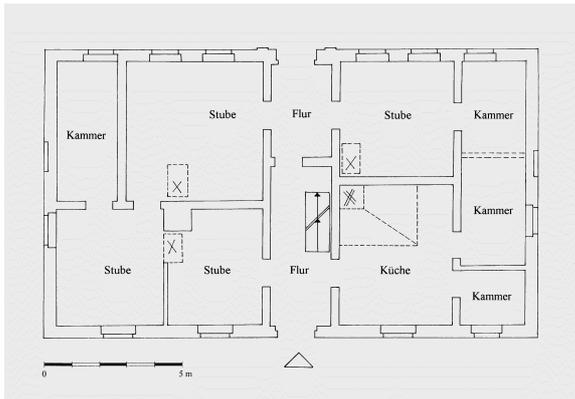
Grundriss des Wohnhauses Letschin, Wilhelmsauer Dorfstr. 26, erbaut bis 1796
